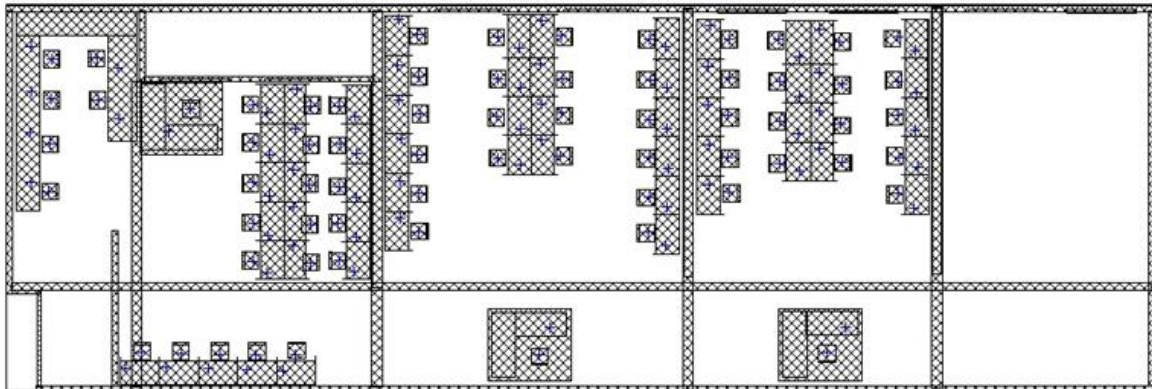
Muestra N°7. Planta e imágenes de los puestos de trabajo.
